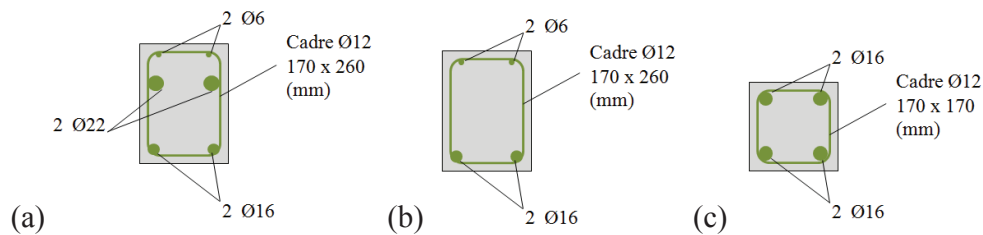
Renforcements de la section (a) aux appuis, (b) en travée de la poutre et (c) du poteau du portique G2
